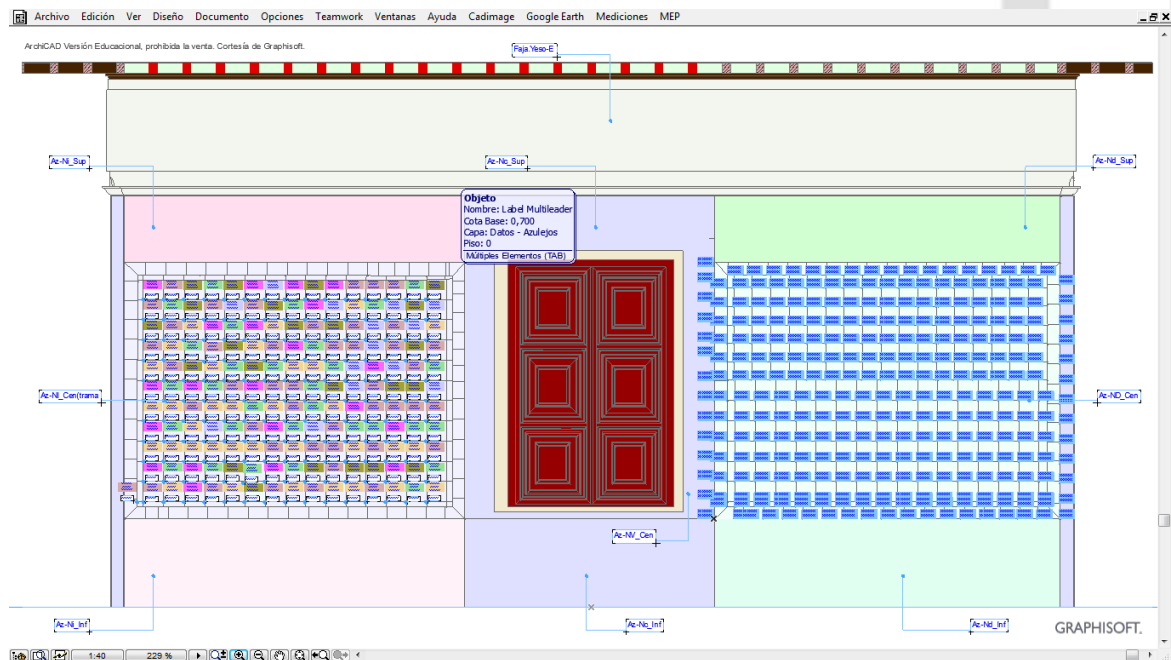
Alzado Norte del Cenador de Carlos V obtenido del modelo BIM con las etiquetas de las piezas.
